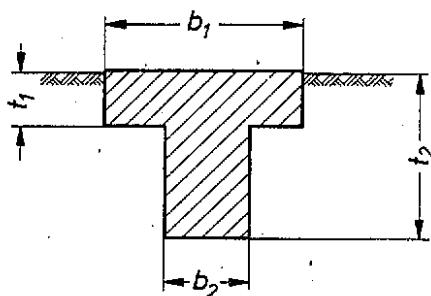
Einspannung im Baugrund bei abnehmender Steifigkeit des Gründungskörpers (λ_p Erdwiderstandsbeiwert γ Bodenwichte)
